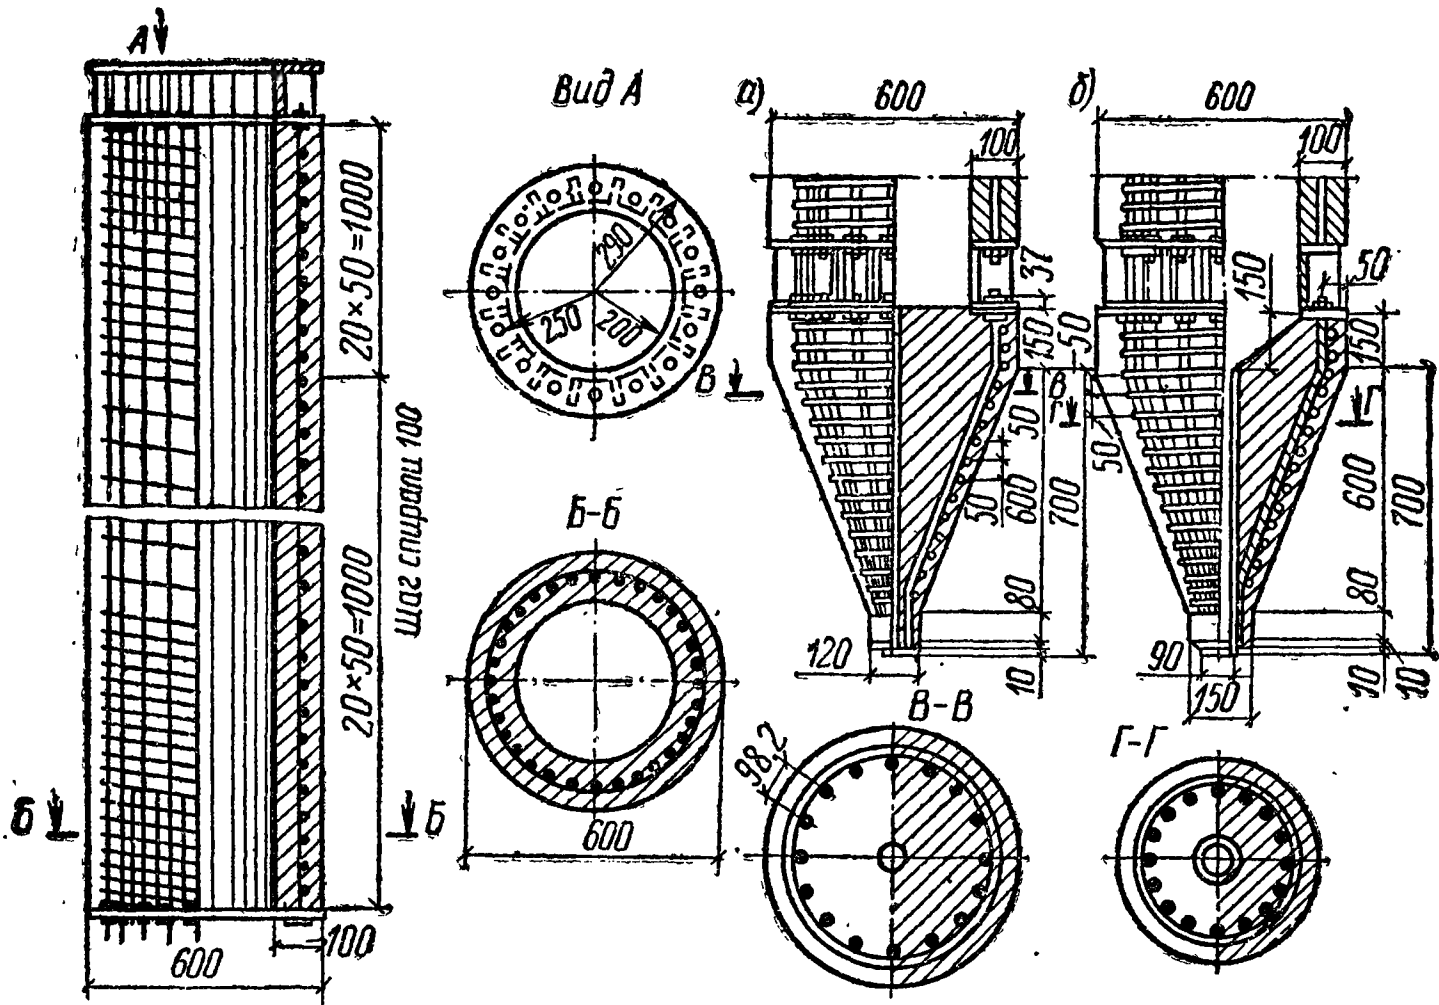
Железобетонная трубчатая свая диаметром 60 см и наконечник к ней
